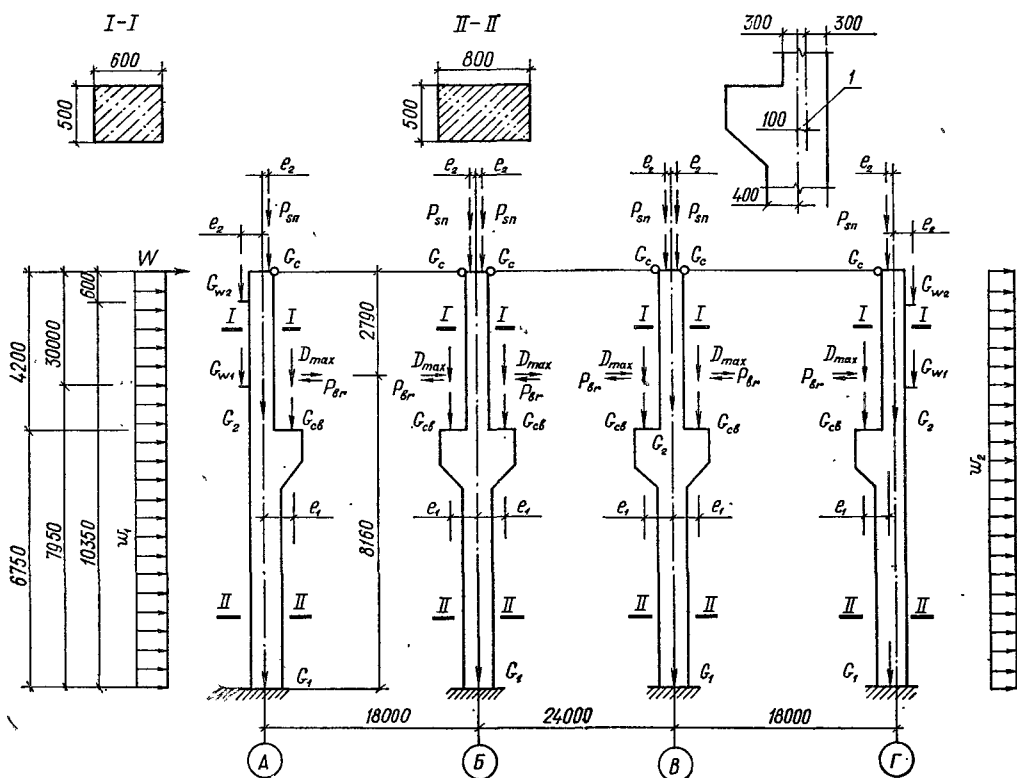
Расчетная схема поперечной рамы и схема нагрузок:
